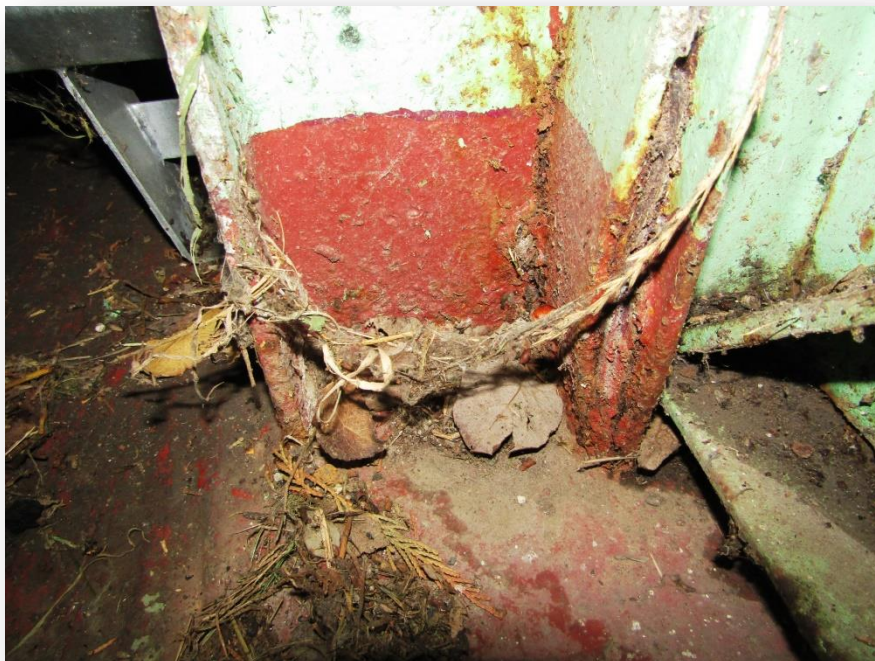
pied de poteau en cours de corrosion.
